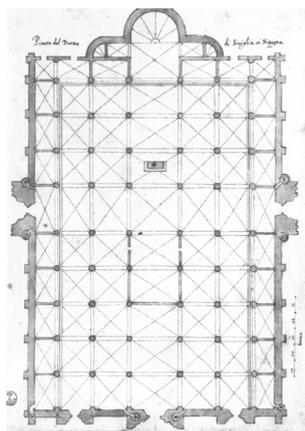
Planta de la catedral de Sevilla. G. Vasari. 1600.
